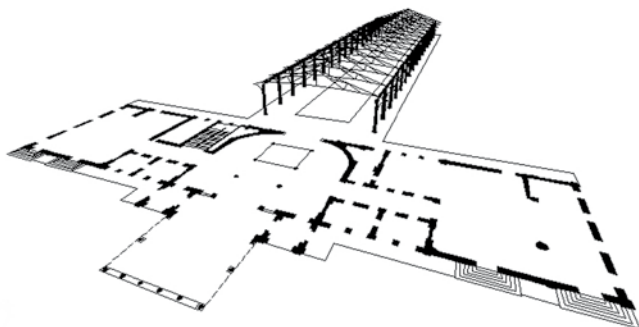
Planta baixa do pavimento térreo e estrutura da plataforma da Estação Central.
